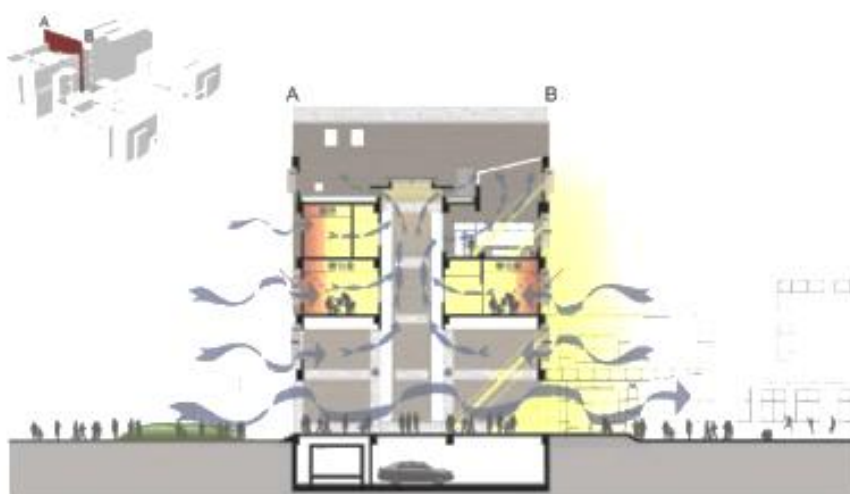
Átrio no centro do Diamond-Level Green Building, em Taiwan.
